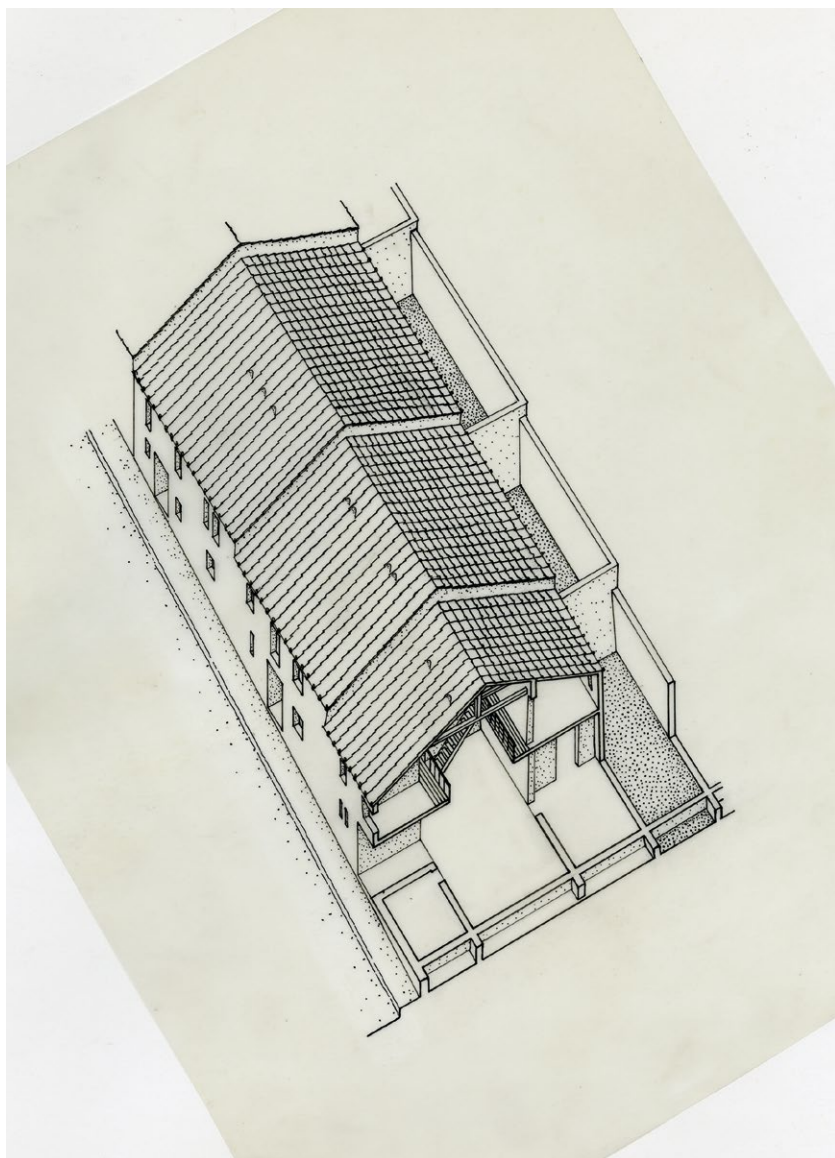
Pompei. Sezione e proposta di ricostruzione dell'alzato delle case I 11, 12–14 secondo A. Hoffmann (scala 1 : 500)
